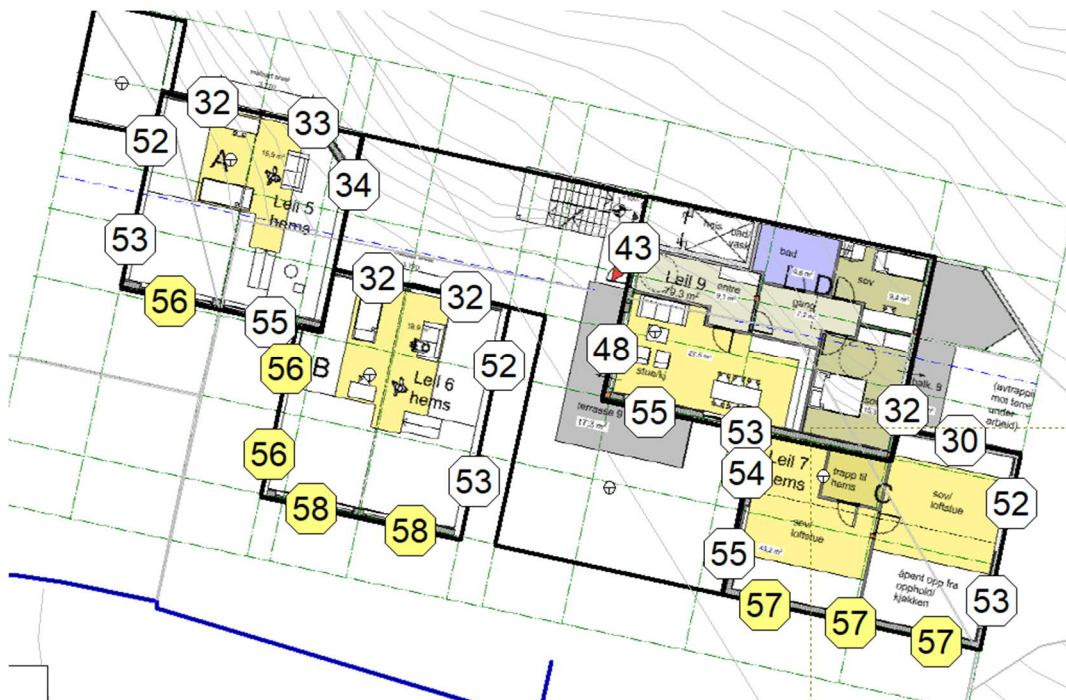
Støynivå, L_{den} , ved fasade plan 0.
